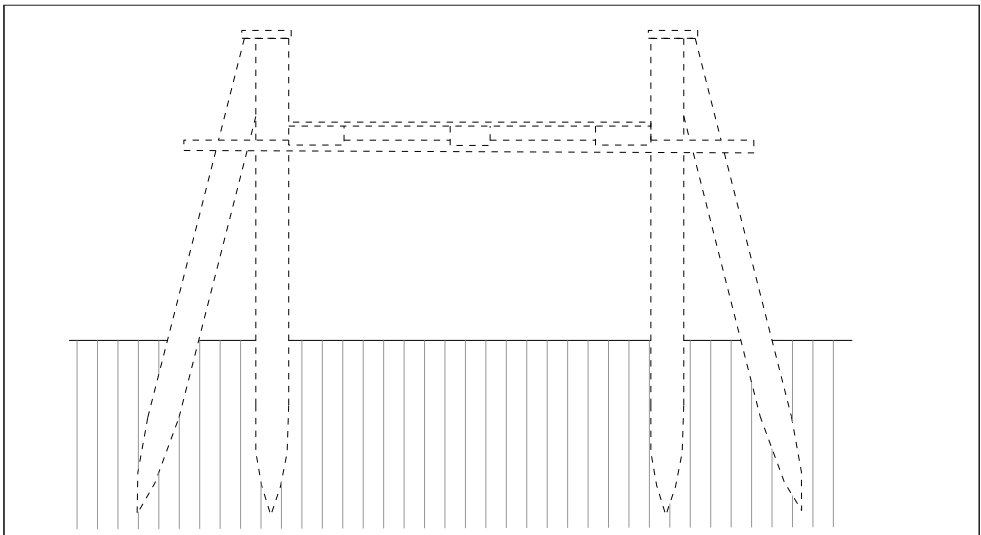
Konstruktionsprinzip eines Brückenjoches der Burgauer Holzbrücke.1844-46.
